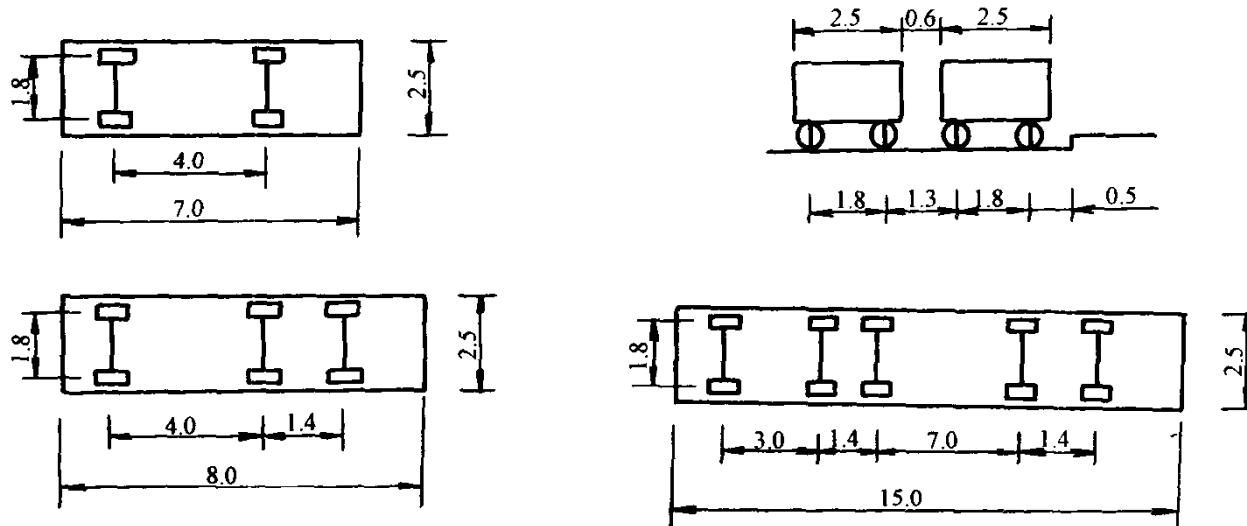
各种设计车辆的平面尺寸和横向布置图(尺寸单位:m)
